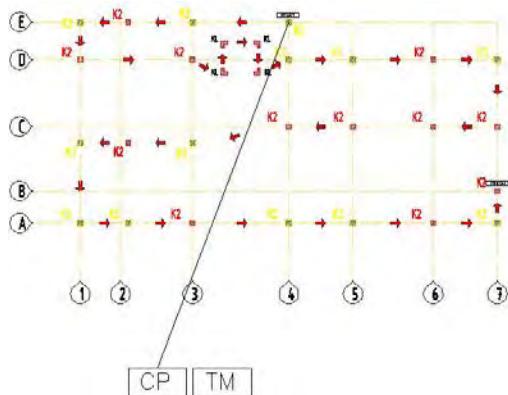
12 Ilustrasi Penuangan Beton dari Truk Mixer ke Kolom
